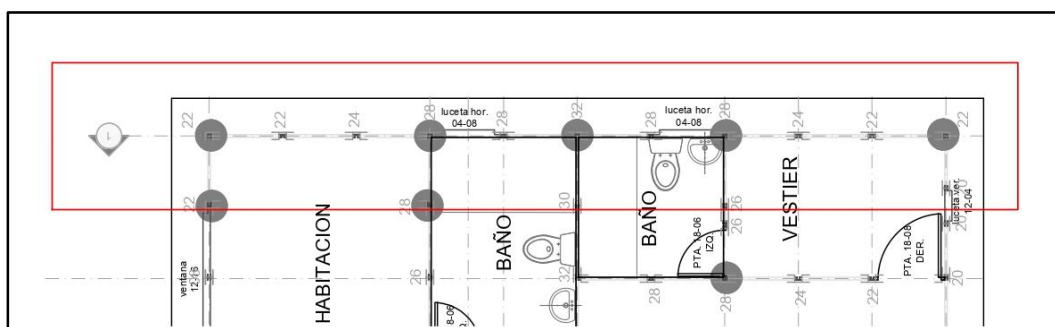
Sección Plano Arquitectónico, identificar alzado
